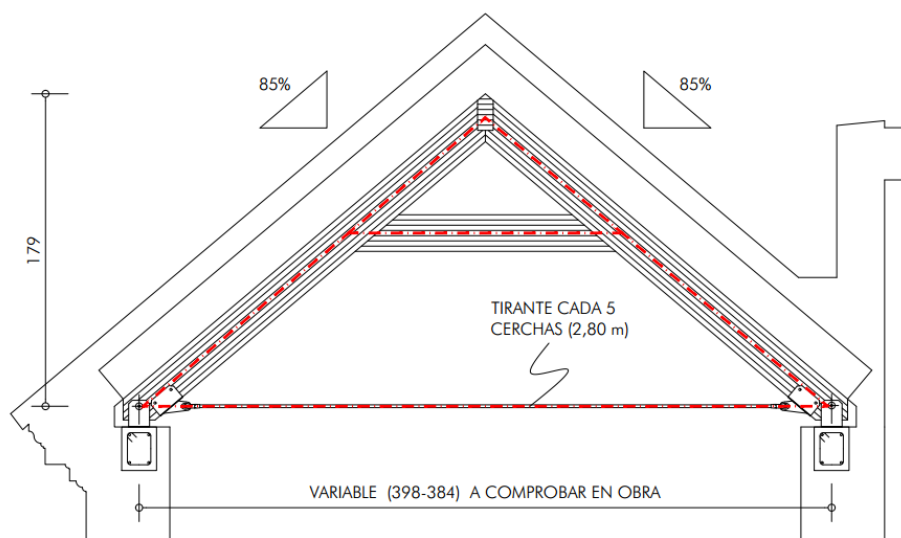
Armadura de par y nudillo proyectada para la cubierta
